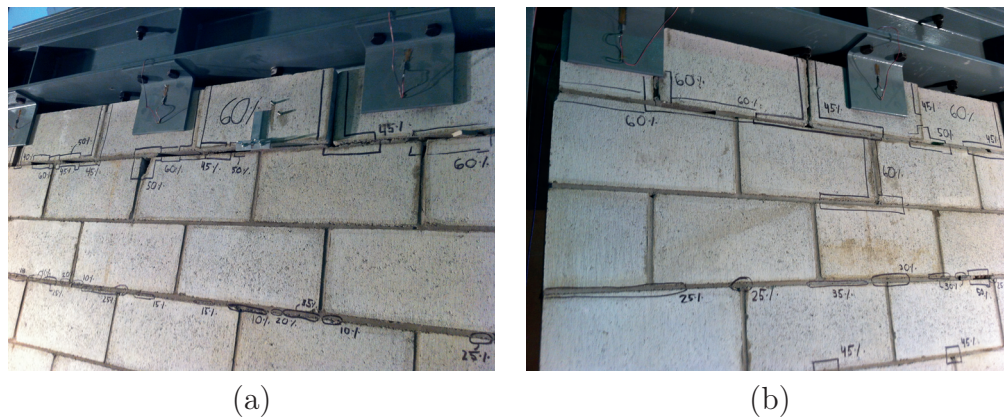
Photos de l'endommagement du mur 1 après l'essai MAL15-0.60 (a) façade avant du mur (b) façade arrière du mur
